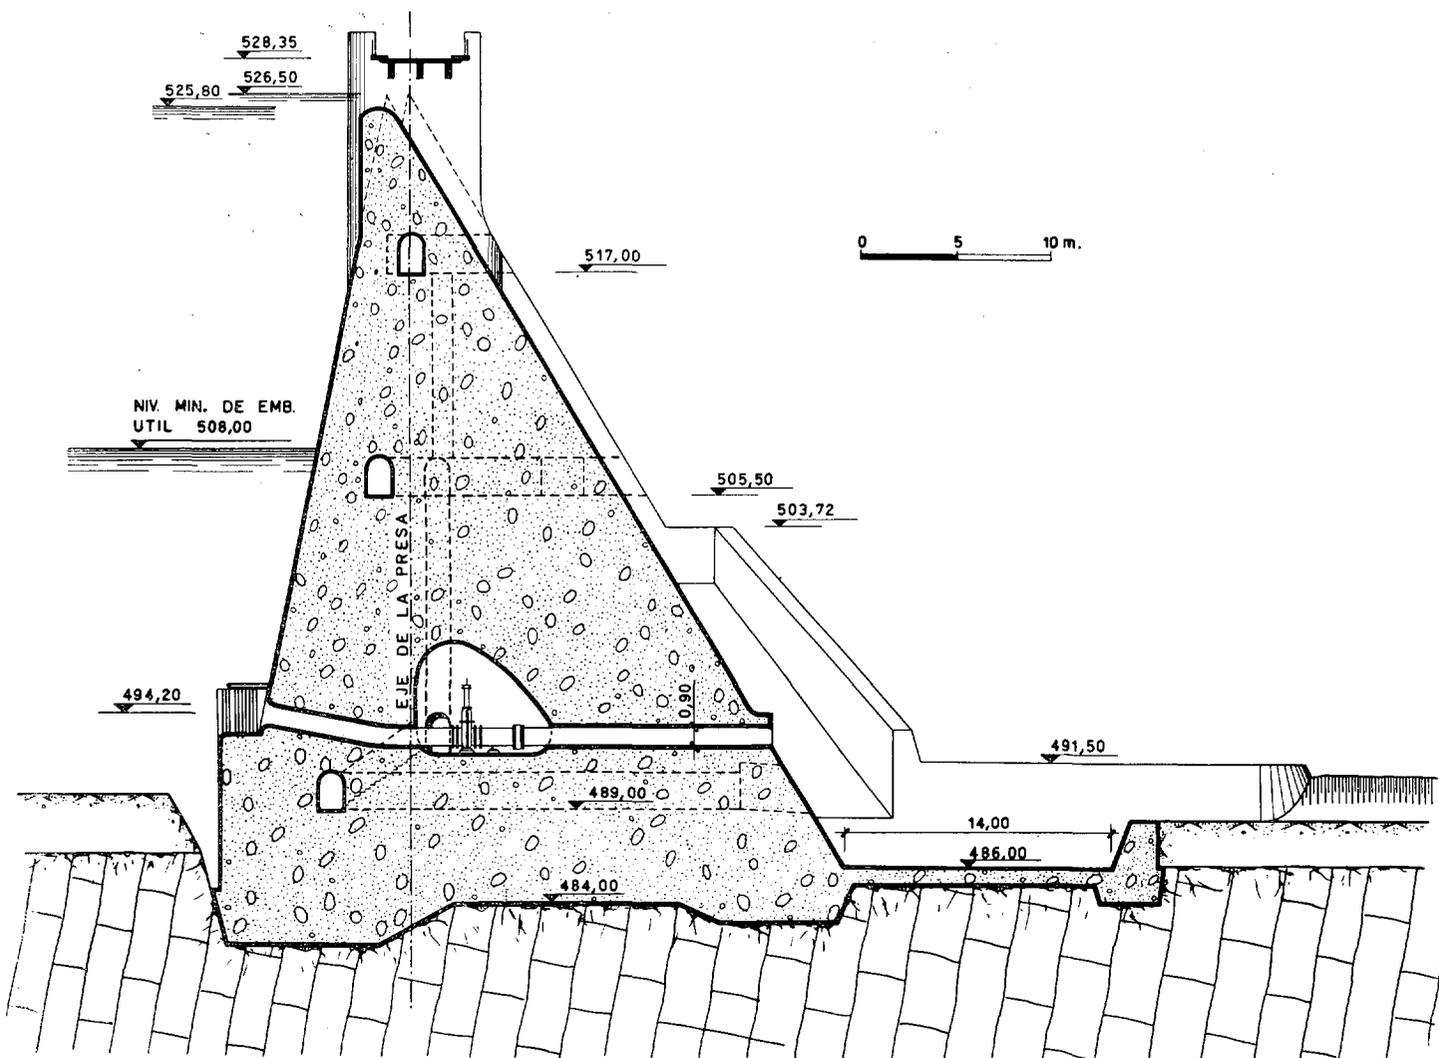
^a — Presa de la Campaña. Sección principal indicando aliviadero y desagüe de fondo.
